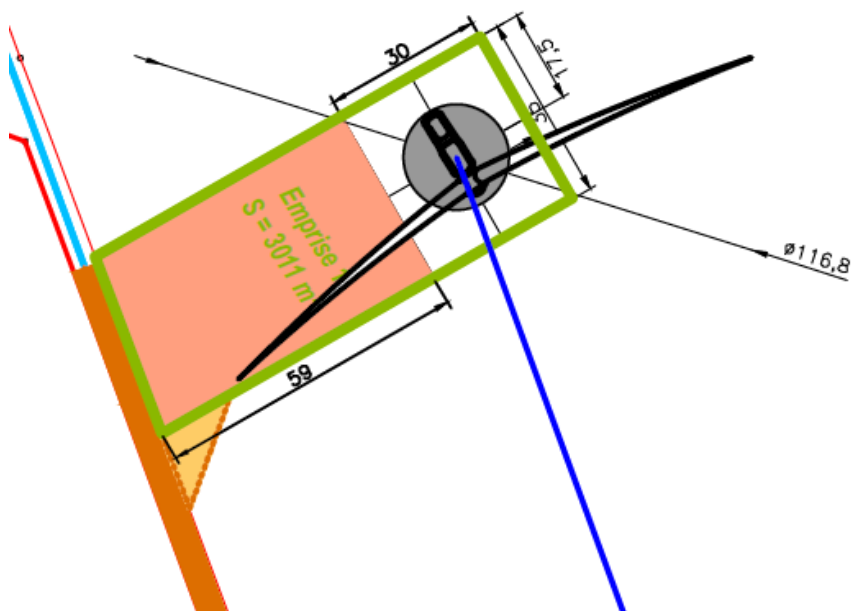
Extrait du plan masse (aménagement de l'éolienne E1)
